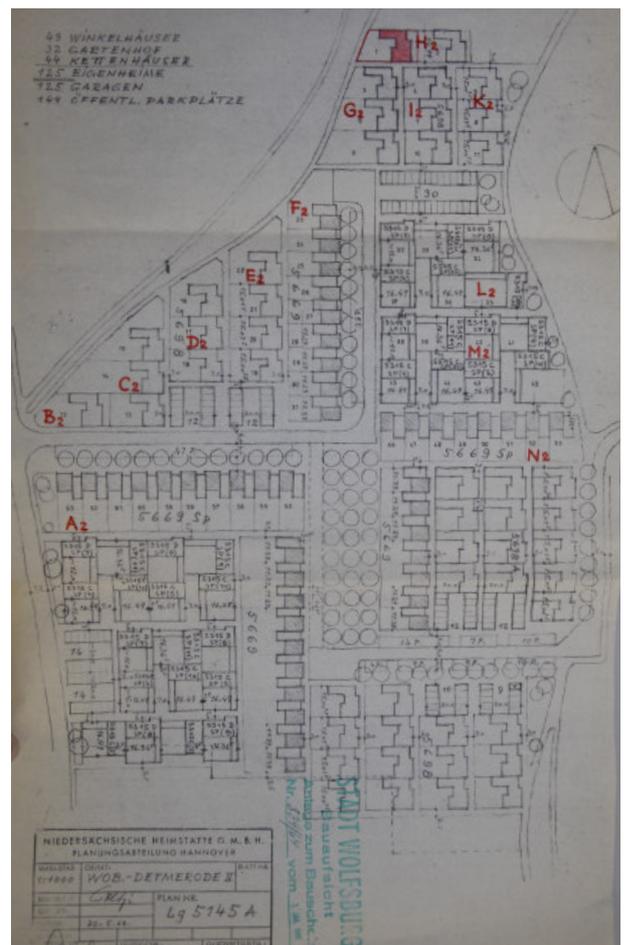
Städtebauliche Struktur Demonstrativbauvorhaben (EFH_02, mit unrealisiertem Südteil) – Quelle: Hausakte Friedrich-Naumann-Straße 47
